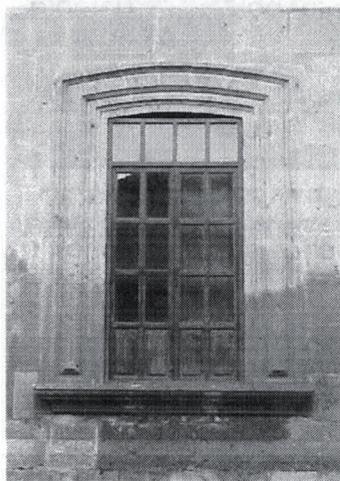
Vano ventana, nivel planta baja fachada Norte y oriente.
